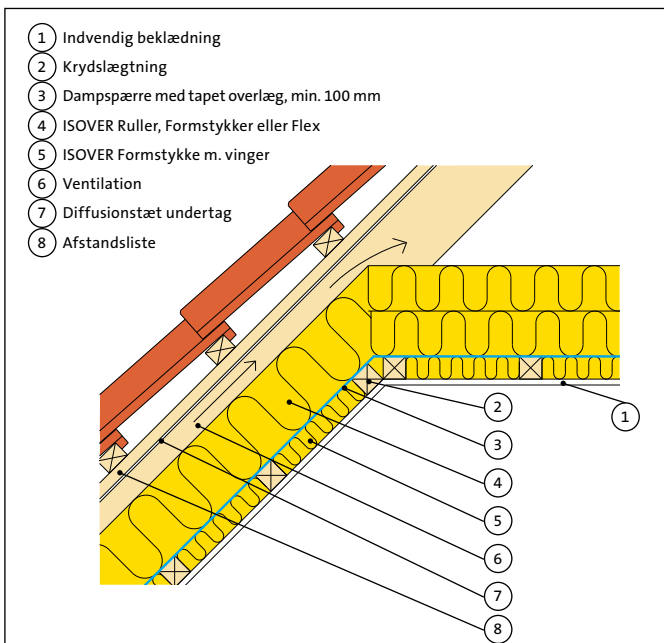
Hanebåndsspær. Skråvægstilslutning til hanebånd. Dampspærre placeret beskyttet i isolering. Diffusionstæt undertag.
